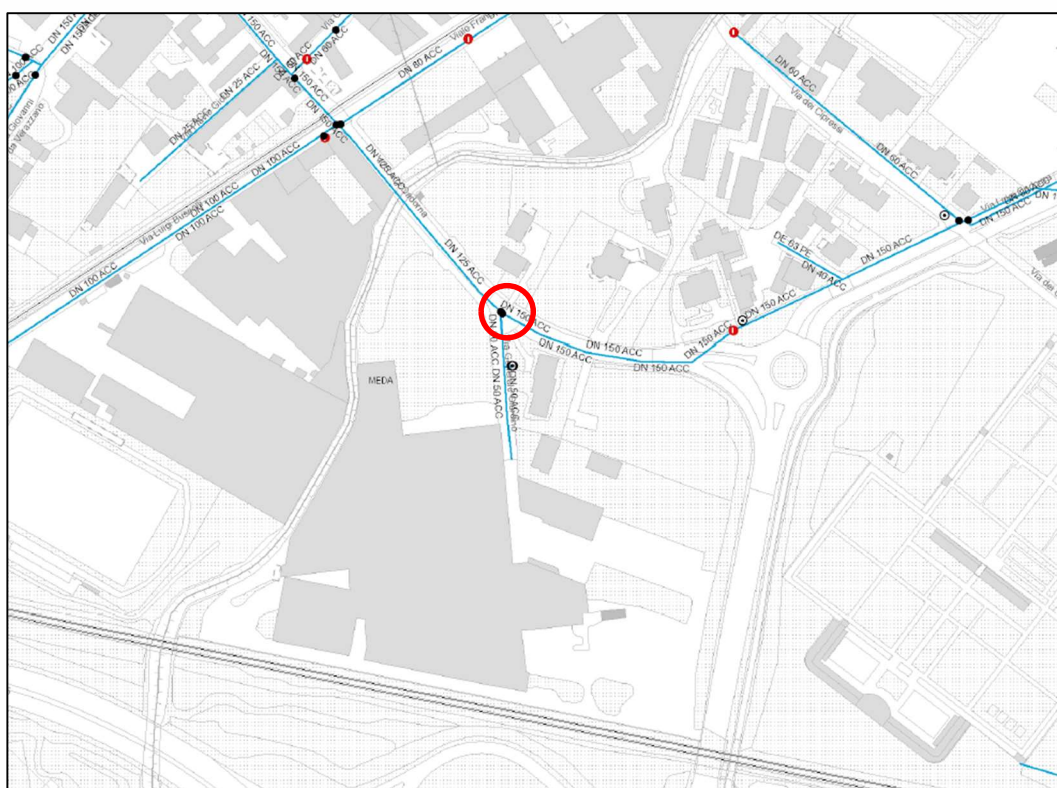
Estratto planimetria rete adduzione idrica esistente nei pressi dell'area di intervento con indicazione in rosso del punto di allaccio.
